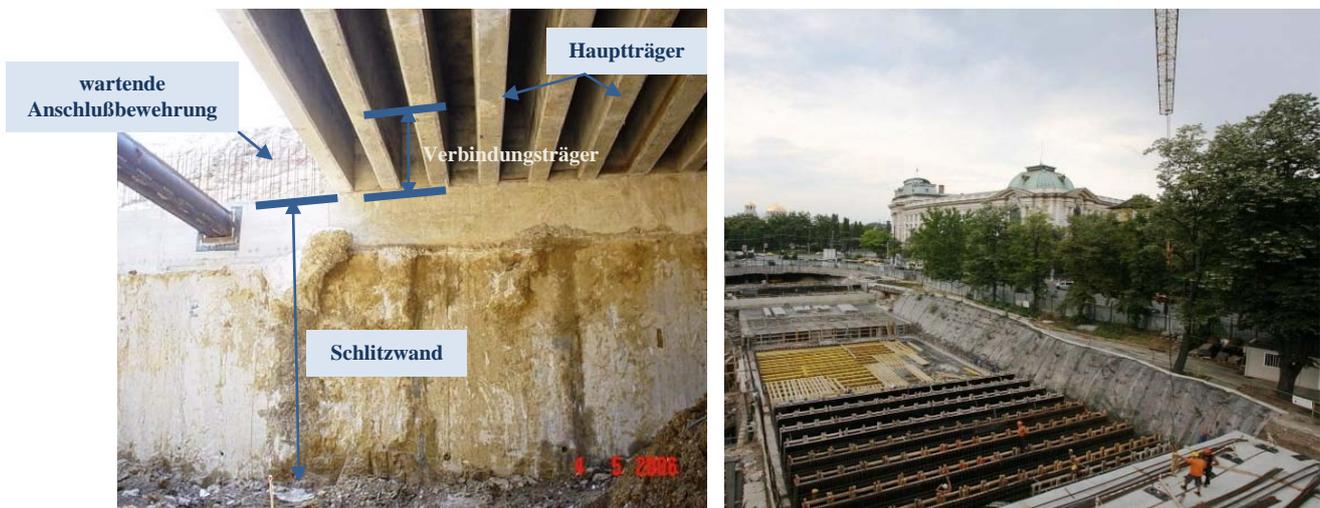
Dachkonstruktion der MS „Kliment Ochridski“ [1.37]
